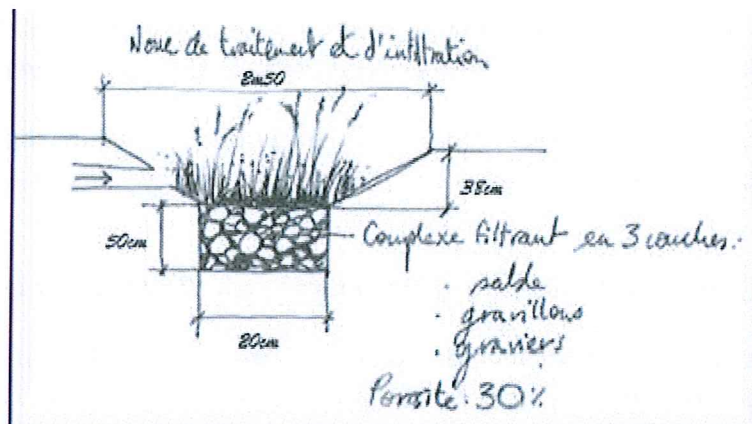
Coupe d'une noue (source : dossier loi sur l'eau, p.73)
